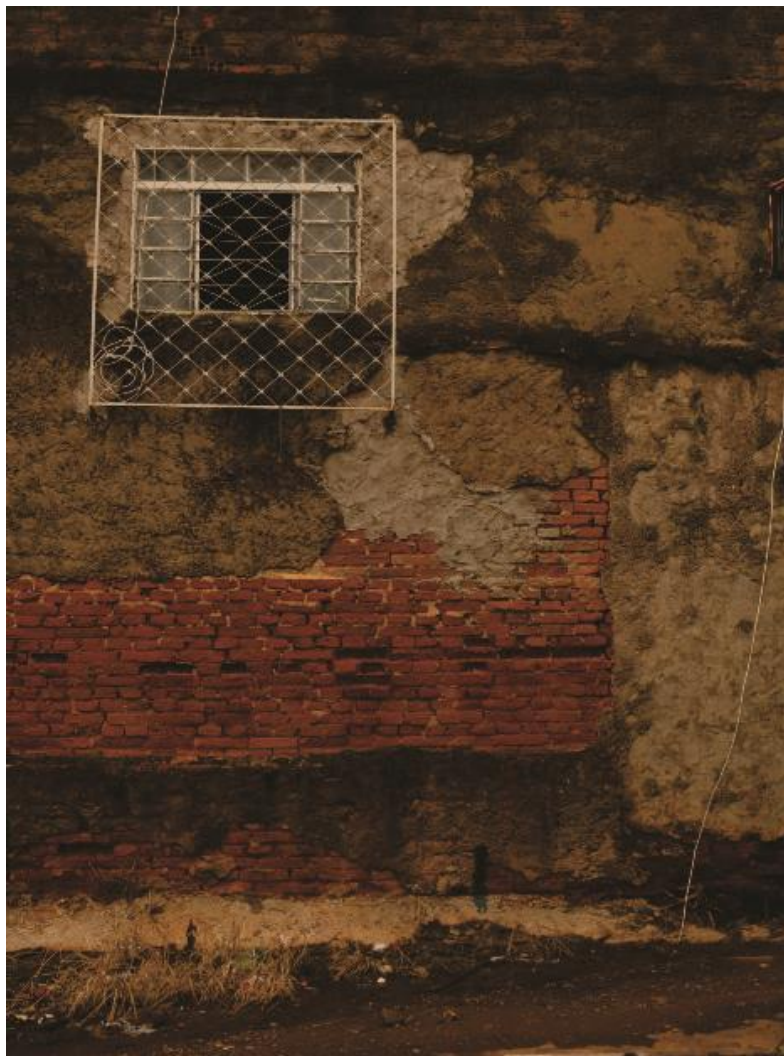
Parede lindeira ao lote concretado da antiga Rua 26-A
